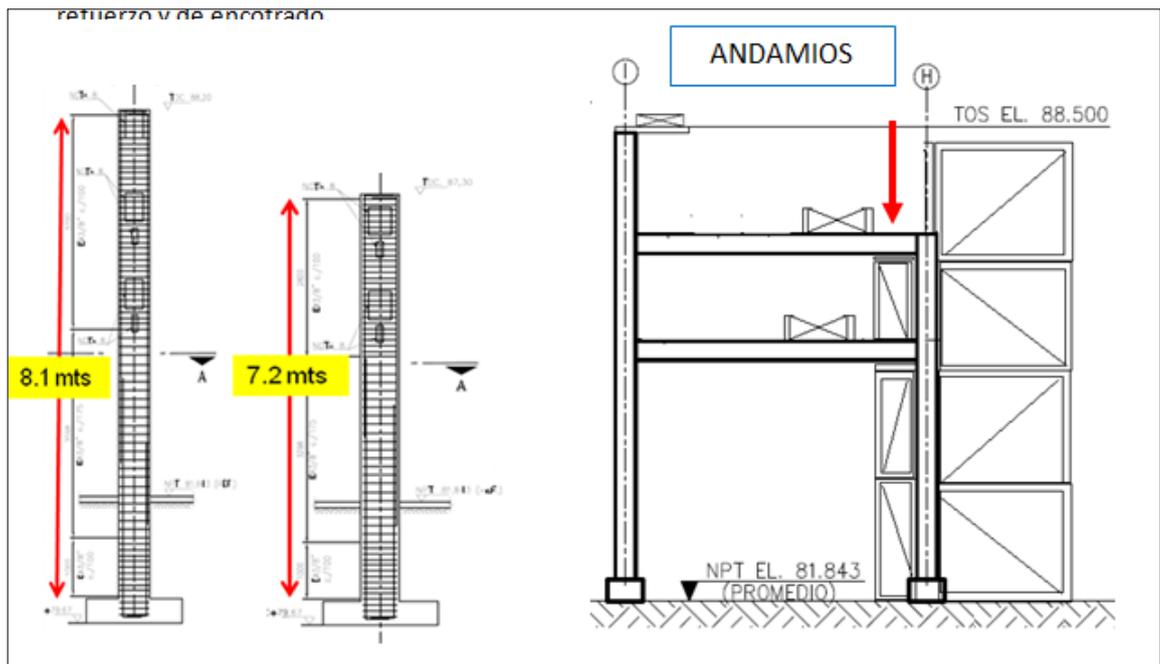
Detalles de acero refuerzo vigas y zapatas de los soportes.
